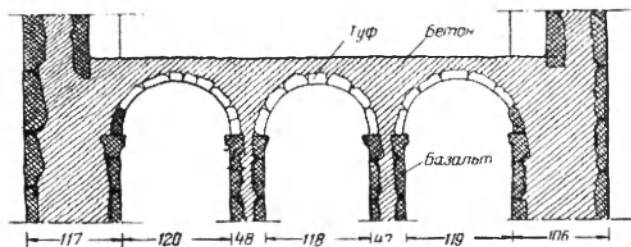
Схема поперечного разреза перекрытий приделов второго этажа колокольни Санаина
